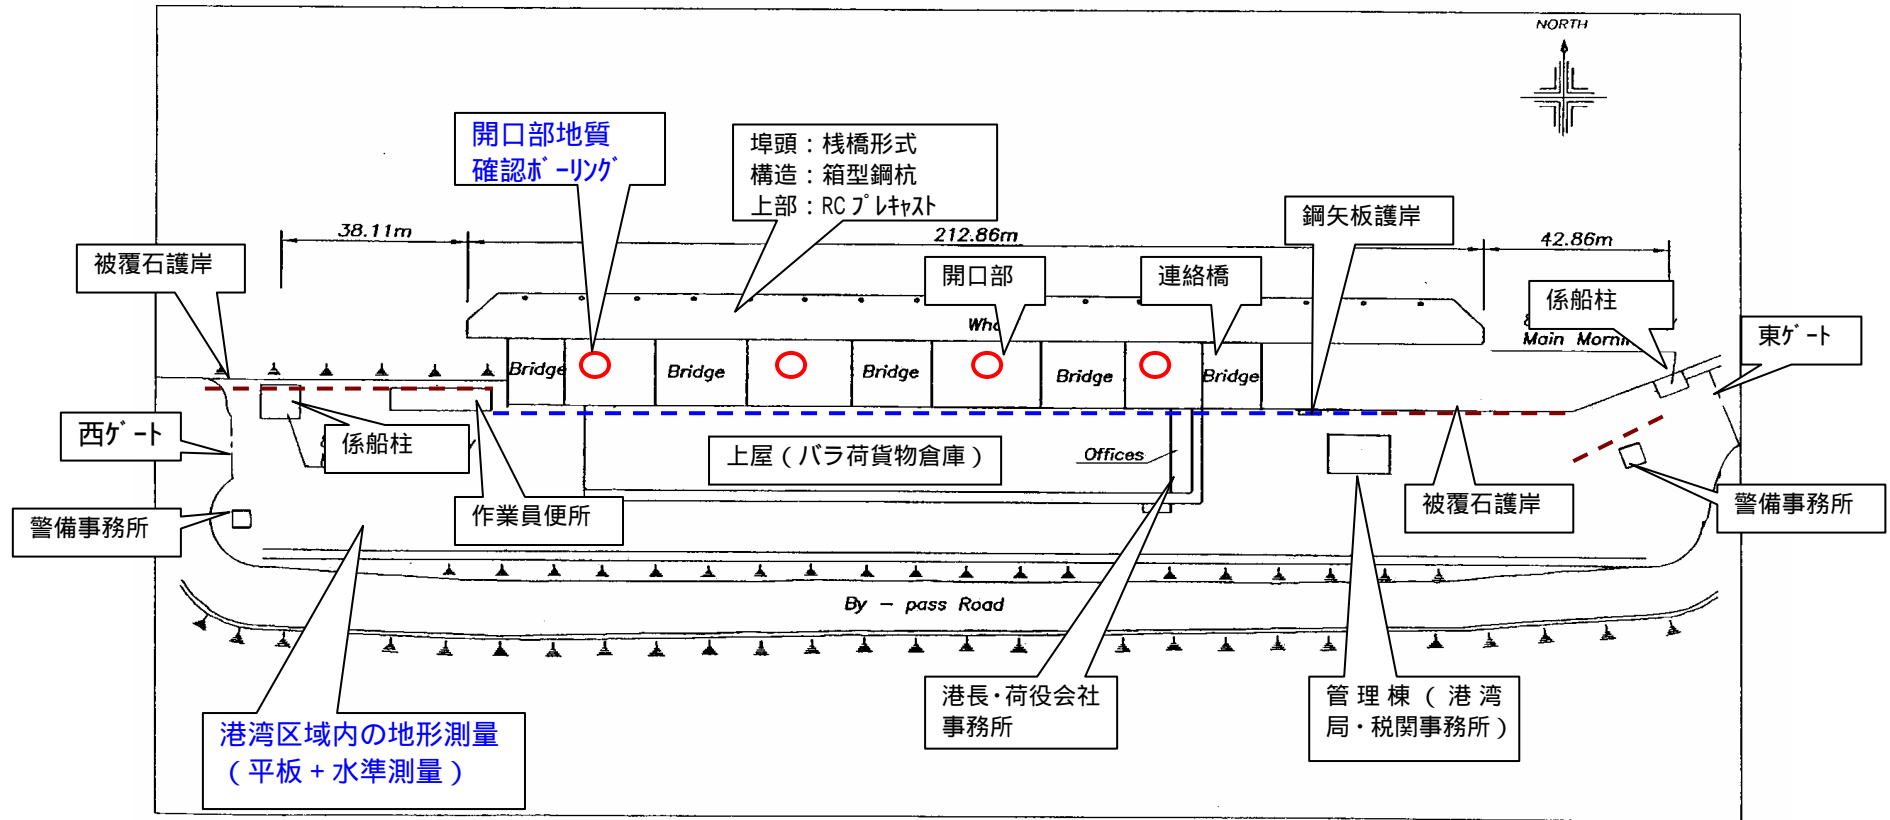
ポートビラ港現況及び自然条件調査平面図
